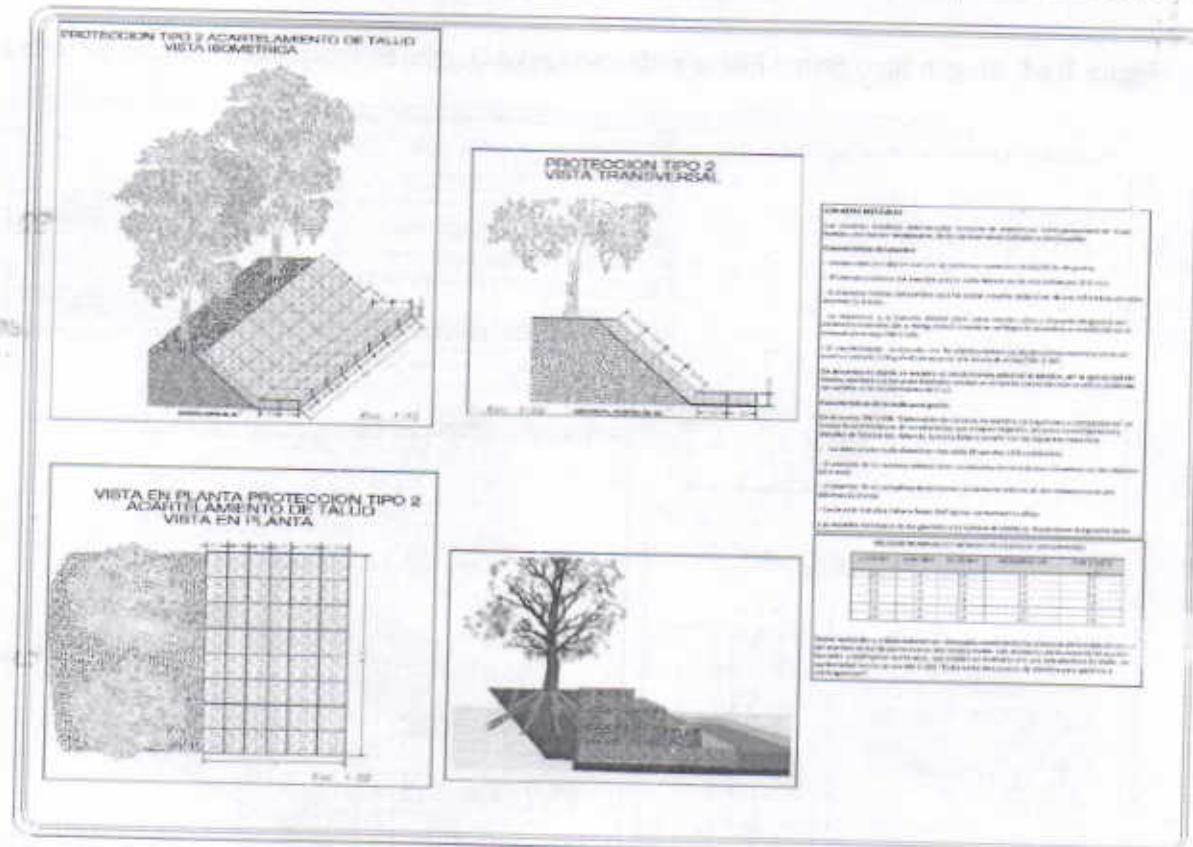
Imagen Tipo, Planos Planta, perfil e isométrico General de solución de protección TIPO No2
